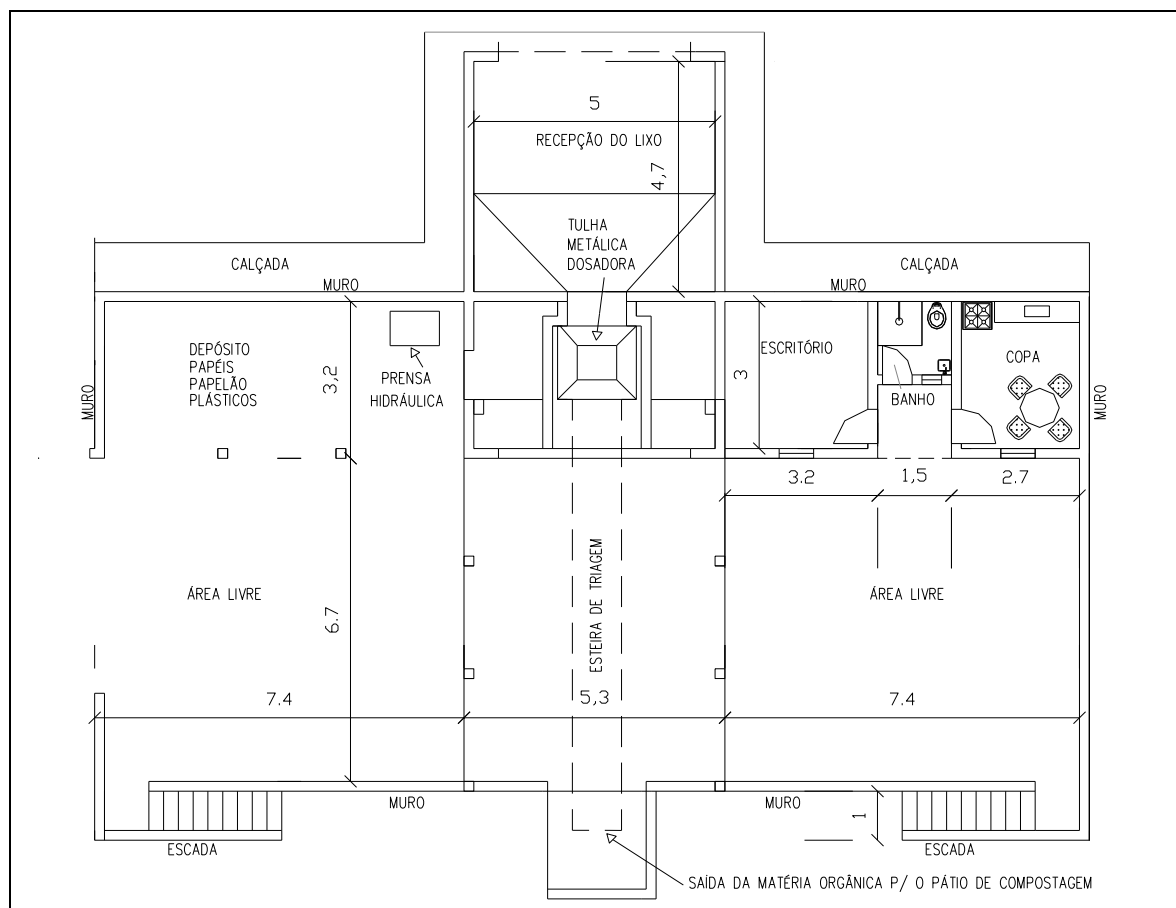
Planta baixa da área coberta da usina de CXC
